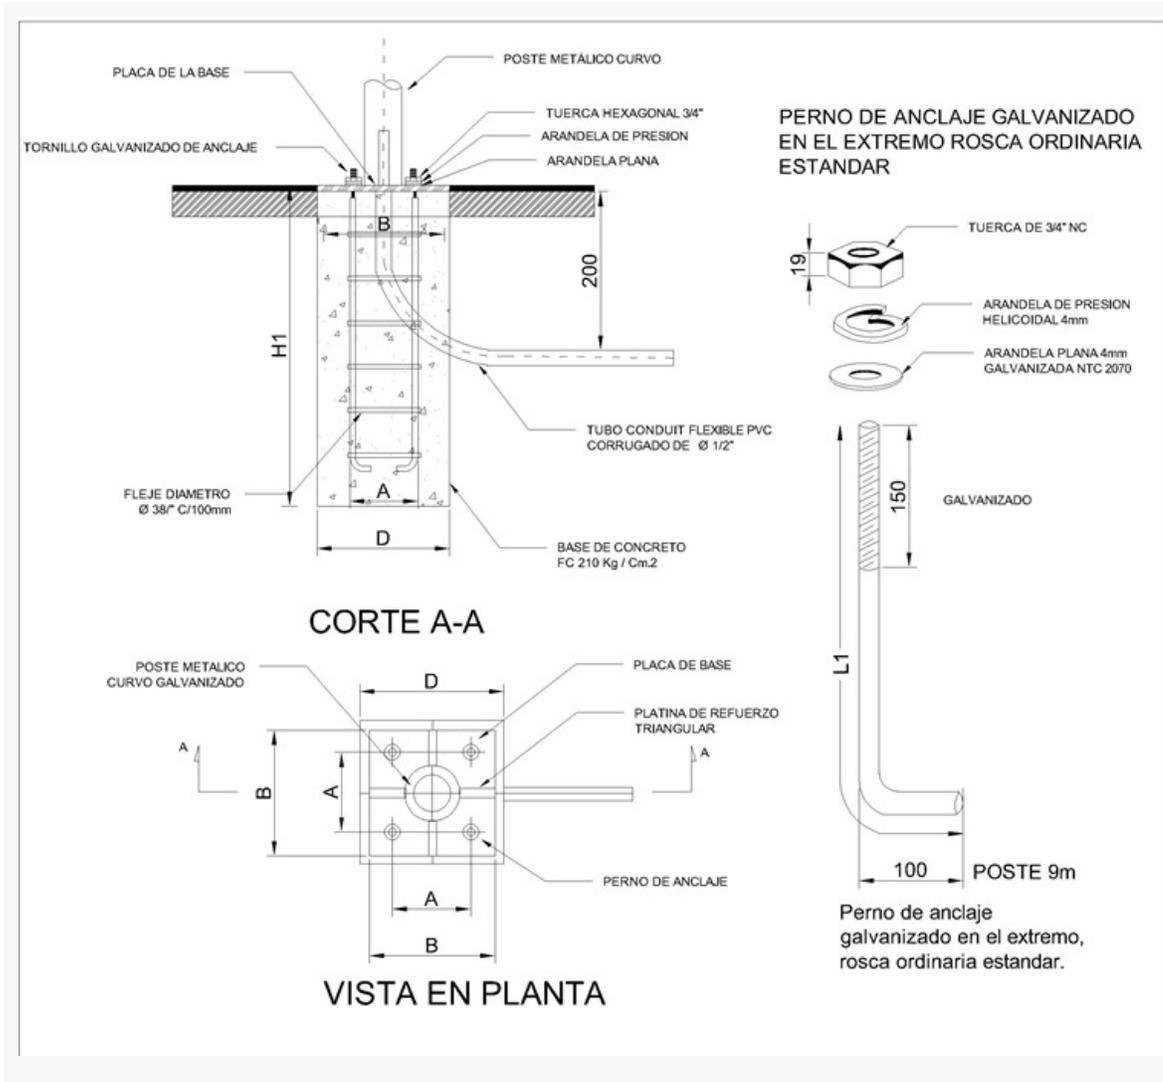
DETALLE CANASTILLA DE ANCLAJE
